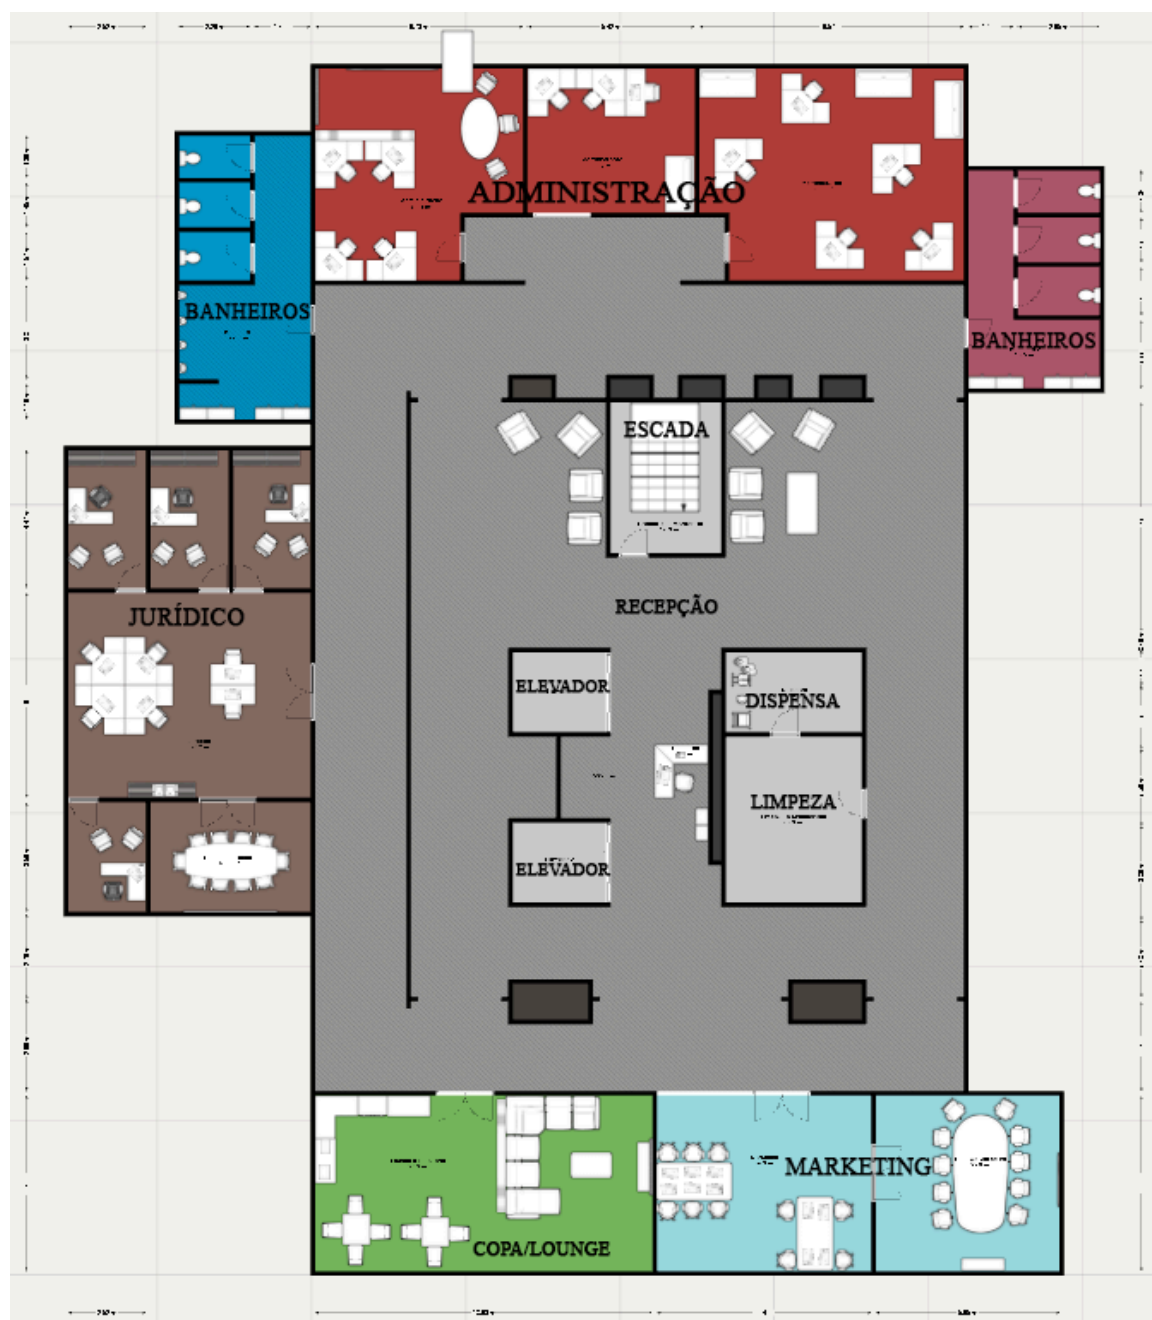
Planta baixa da filial no Rio de Janeiro
